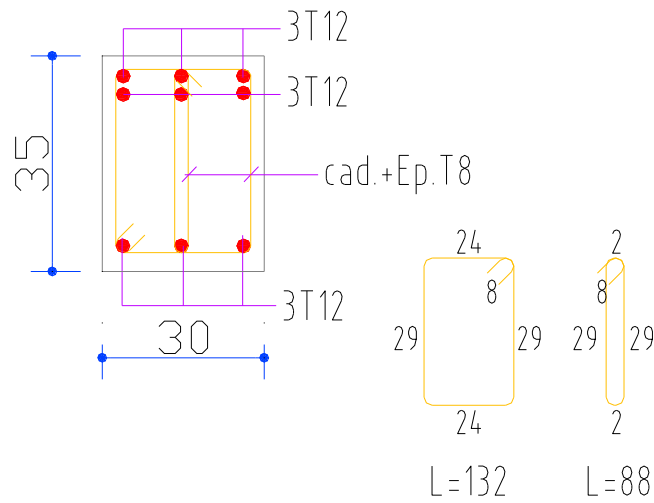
Ferrailage des poutres secondaires au niveau d'appui de niveaux sous-sol.
